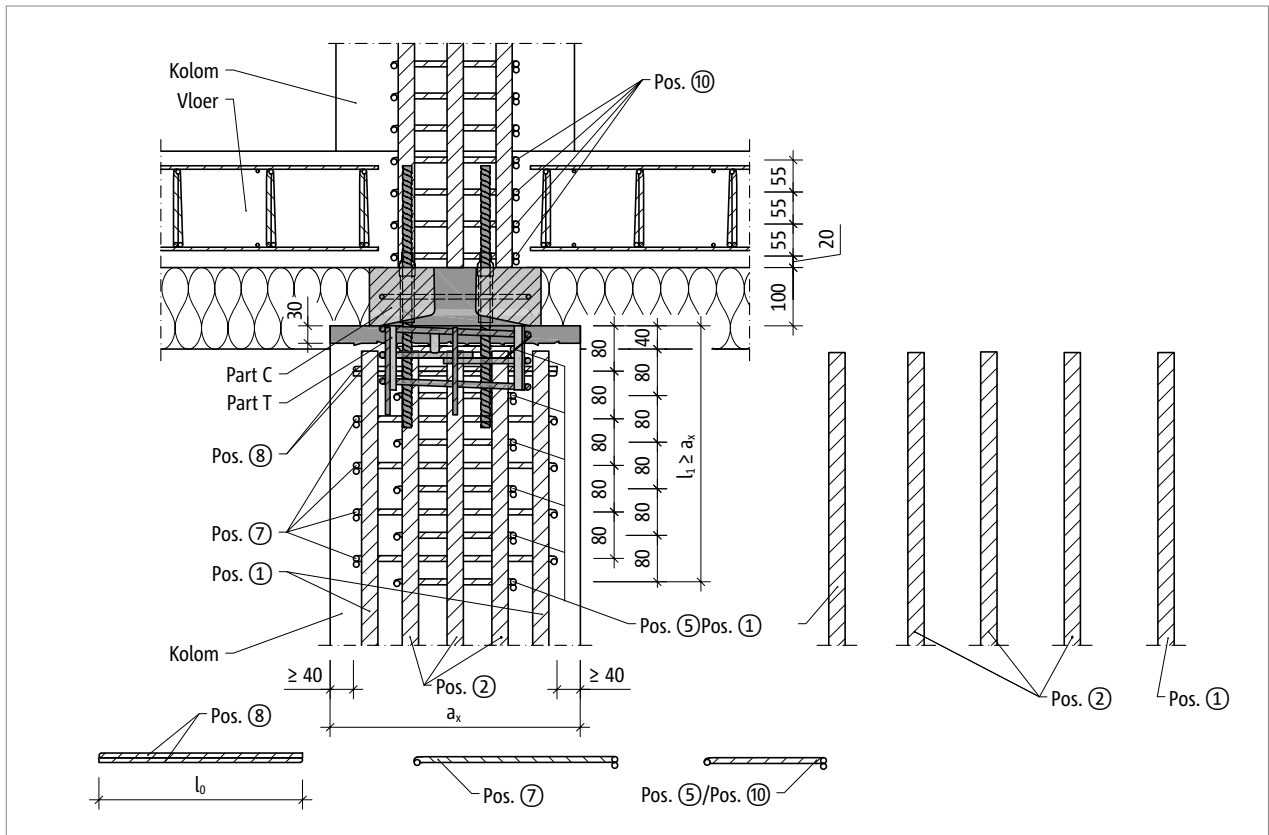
Schöck Scconnex® type P: bijlegwapening in het lengteprofiel van de kolom A-A
